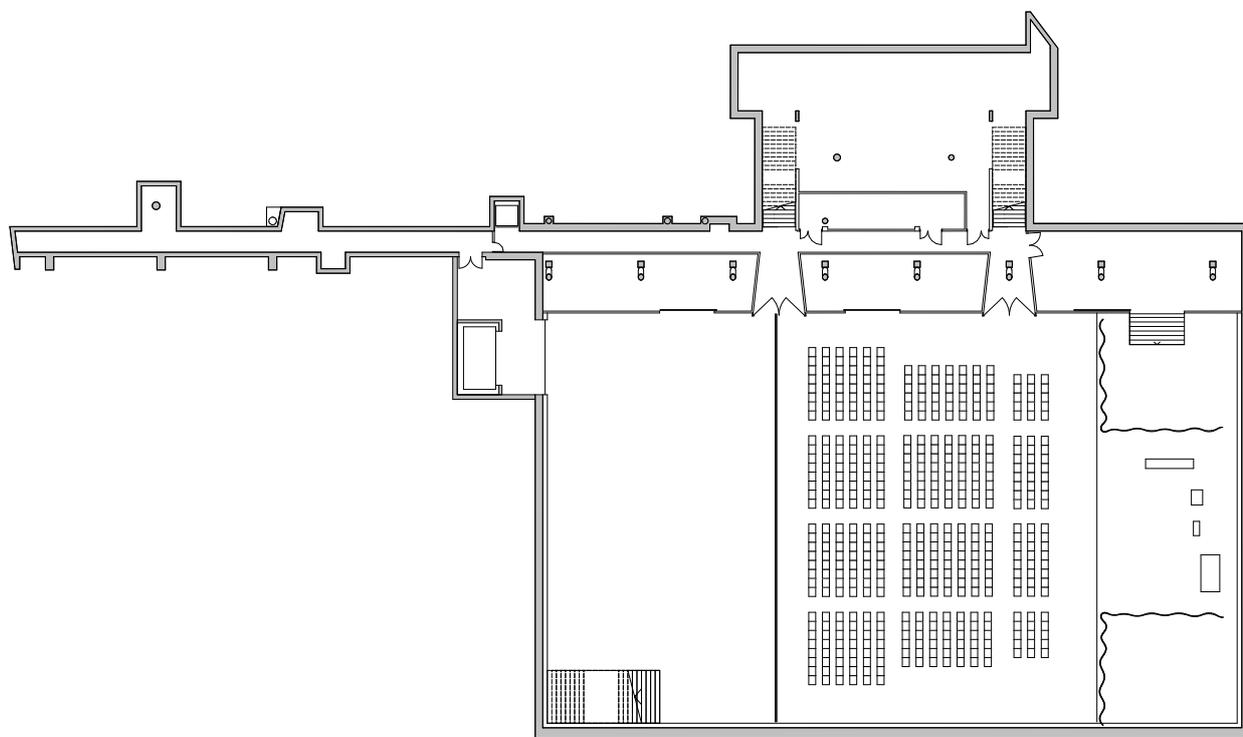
Grundriss 2.UG - kleine Veranstaltung
